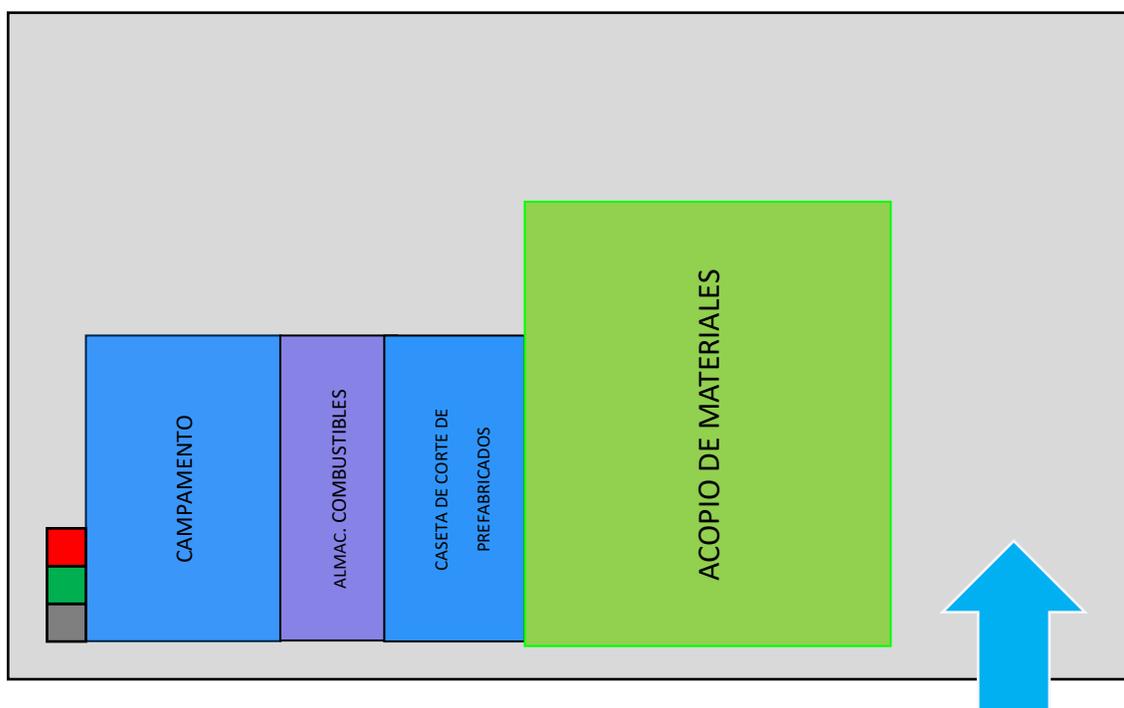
Plano planta de campamento preliminar de obra Calle 72 (Identificación de áreas de almanecamiento)
